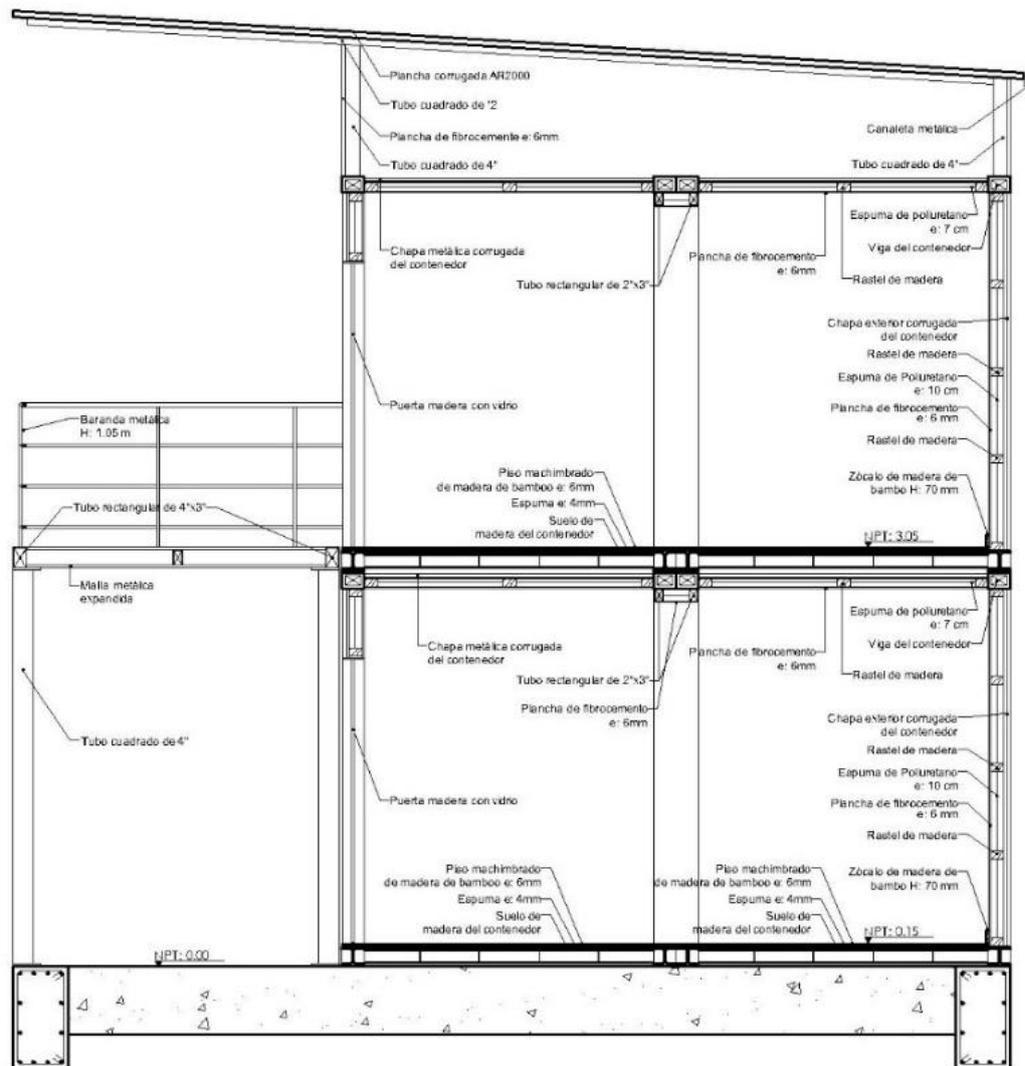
Detalle de estructura metálica en módulo de dos contenedores
